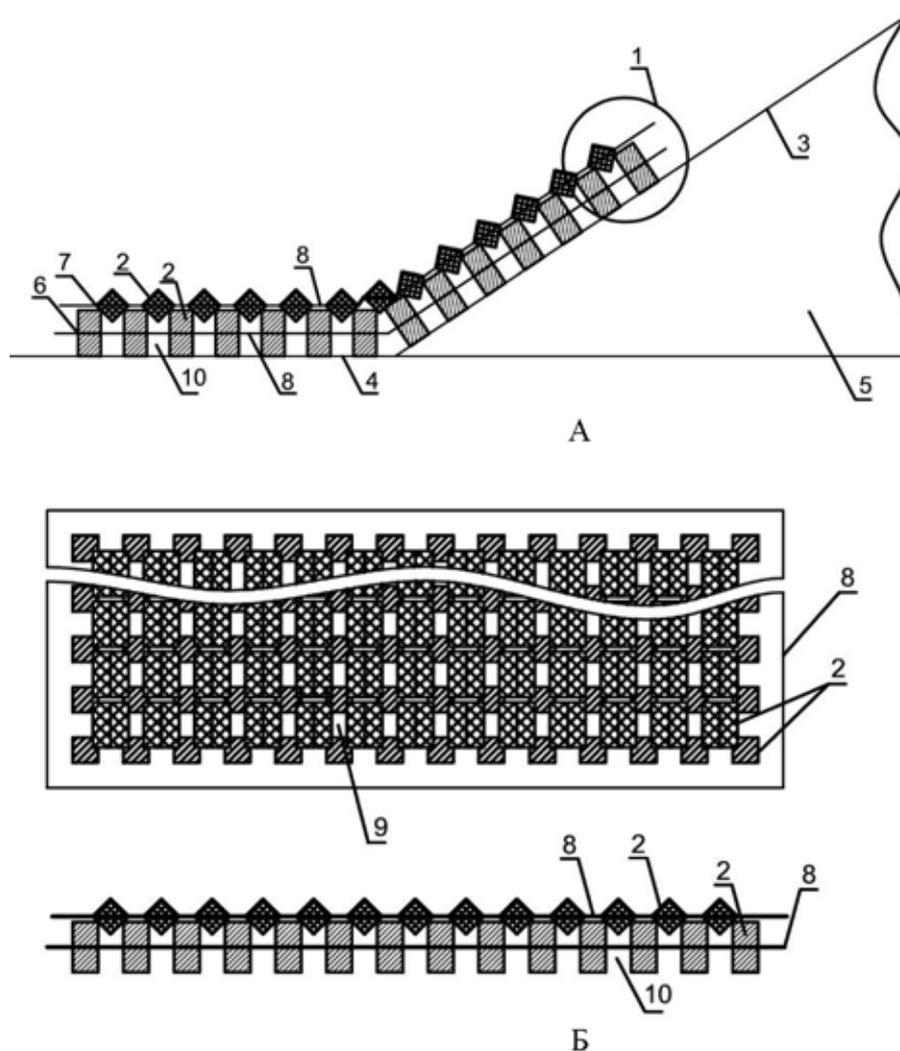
Охлаждающая конструкция. А) продольный разрез охлаждающей конструкции, размещенной на поверхности откоса и приподошвенной зоны земляного сооружения; Б) вид сверху и продольный разрез охлаждающей конструкции: 1 — покрытие из каменной наброски; 2 — искусственные камни; 3 — откос земляного сооружения; 4 — приподошвенная зона земляного сооружения; 5 — земляное сооружение; 6 — нижний слой конструкции; 7 — верхний слой конструкции; 8 — геосинтетическая сетка; 9 — воздушные поры; 10 — воздушные полости.
